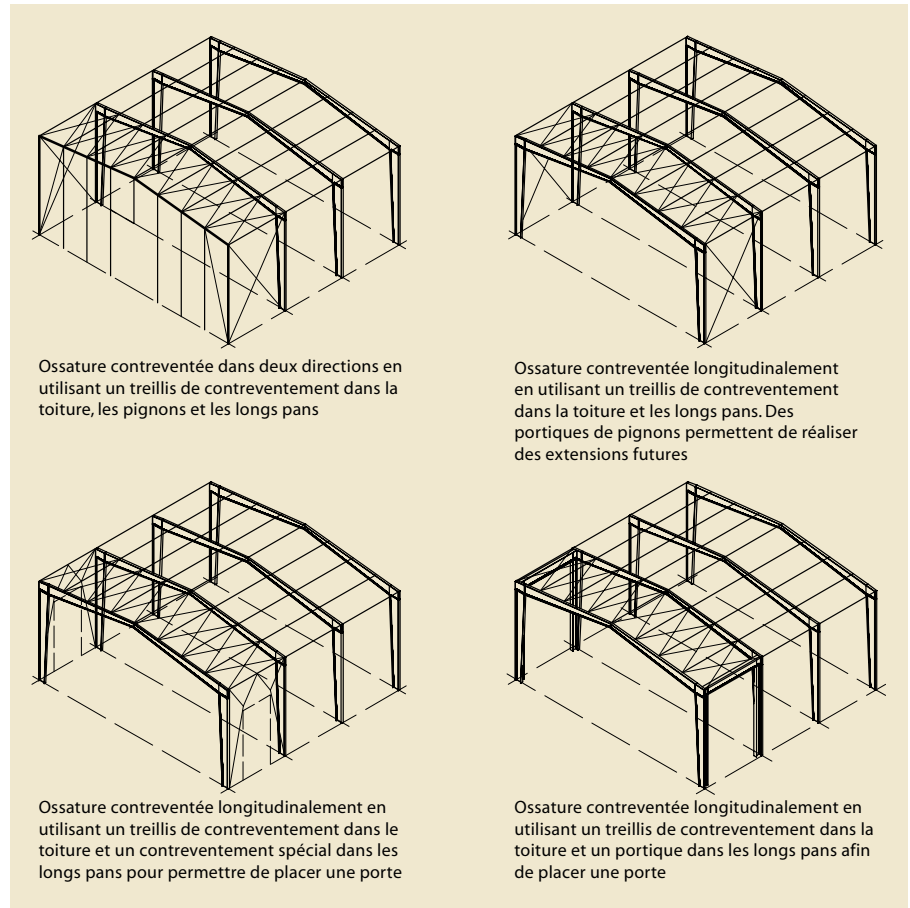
Exemples de contreventement hors du plan d'un portique
